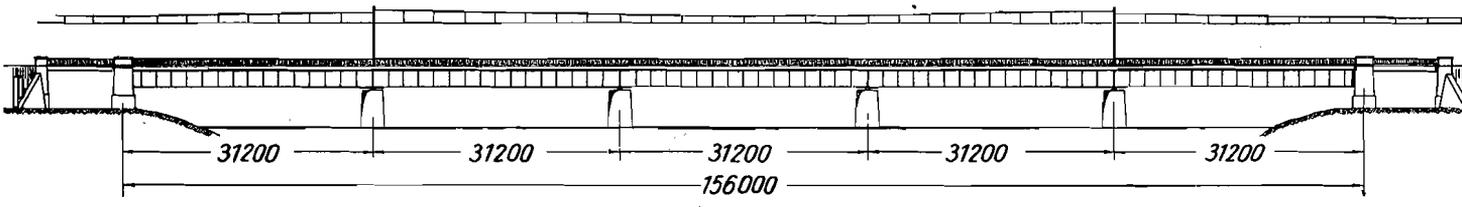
Salzachbrücke Strecke Rosenheim—Salzburg (Ansicht)
